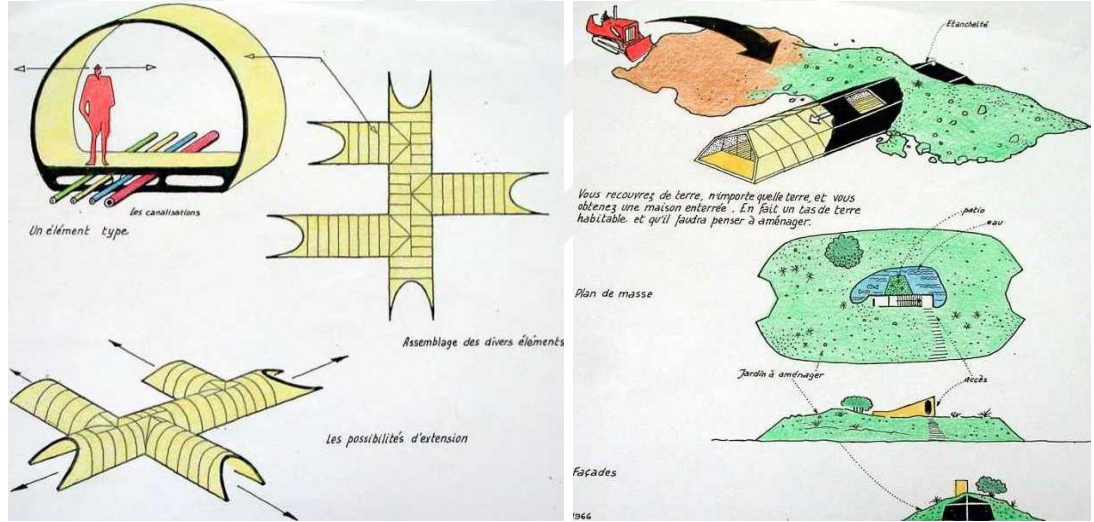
Gömülü Ev'in Kesiti, Görünüşü ve Vaziyet Planı
